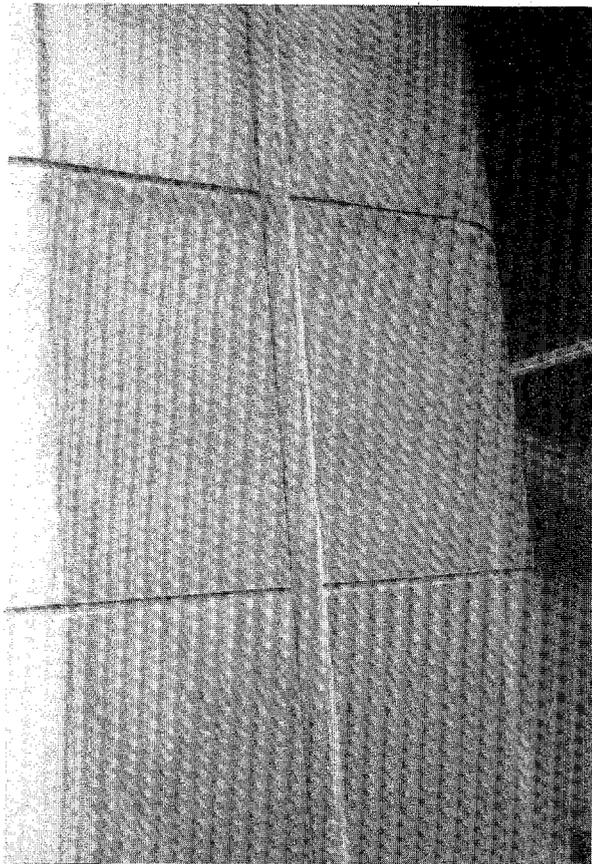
Fissuration d'une pile limitée à l'habillage.
